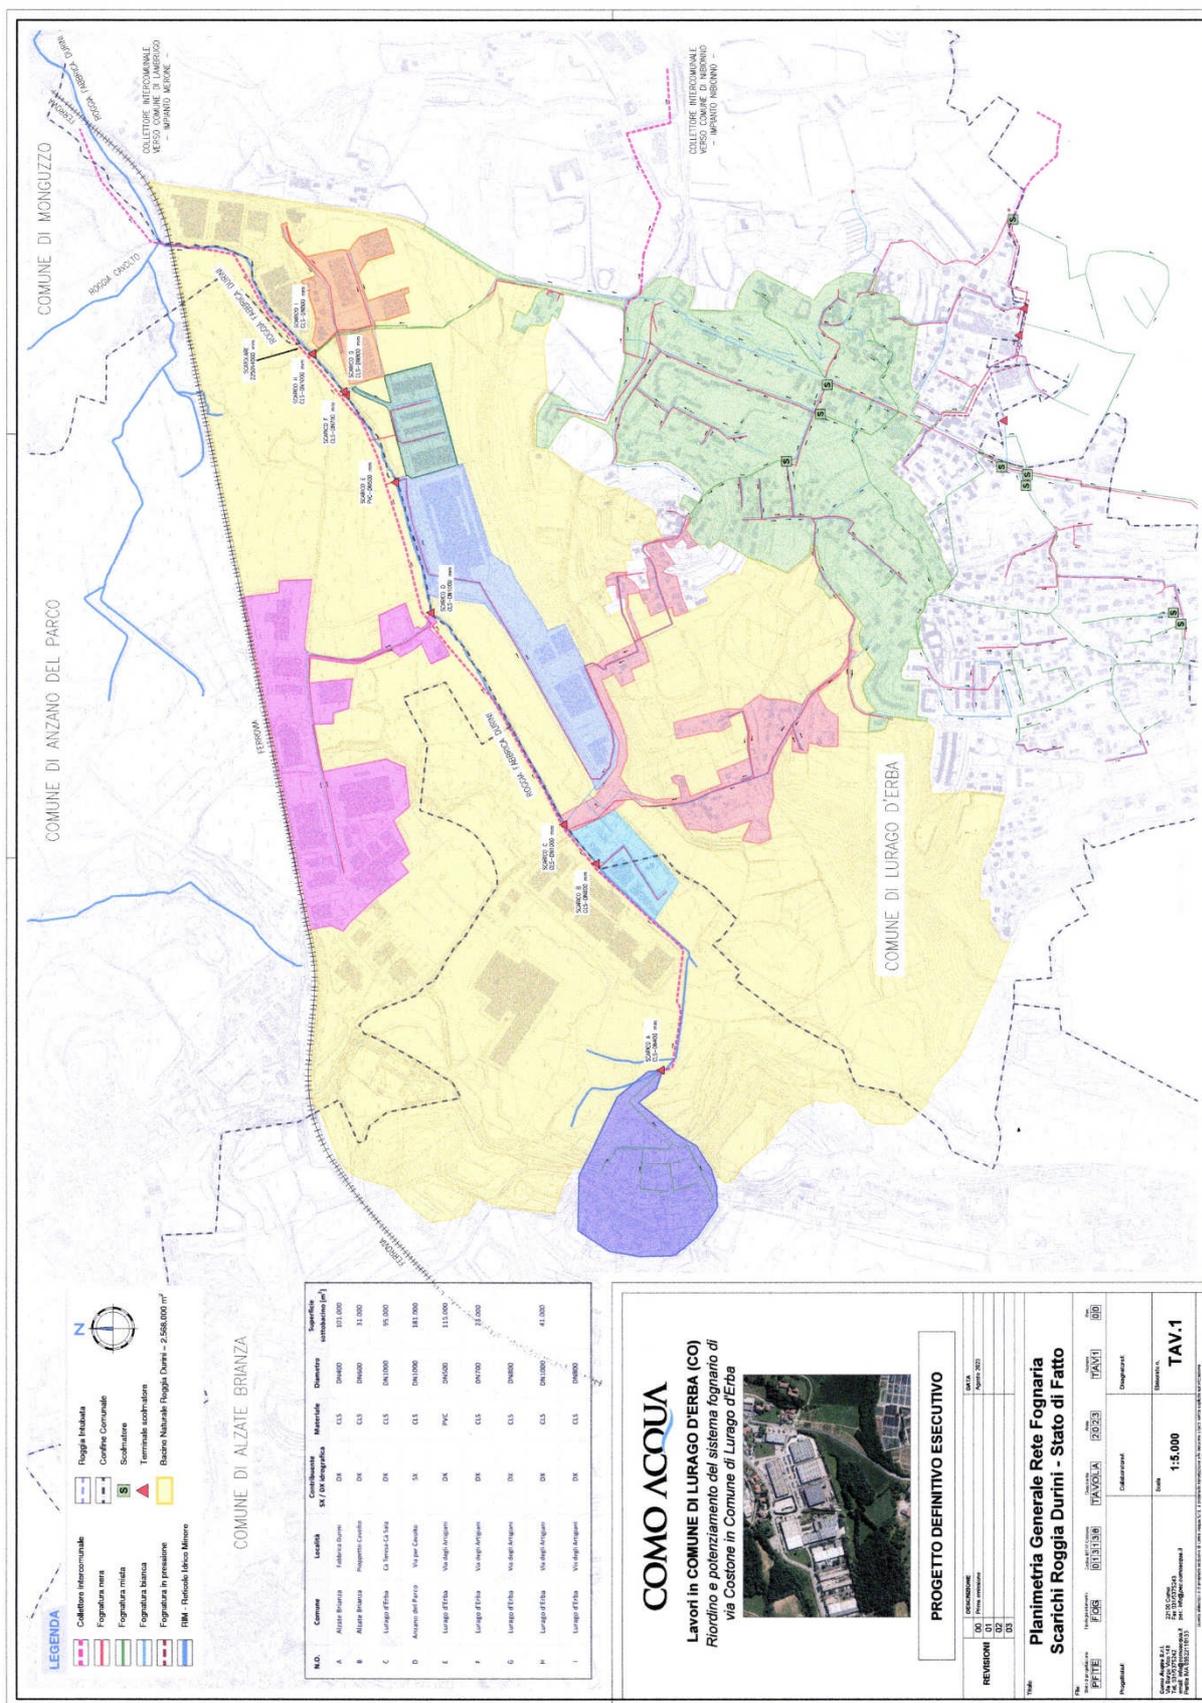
Progetto Rev. 09/2023 – Planimetria generale scarichi Roggia Durini – Stato di Fatto
